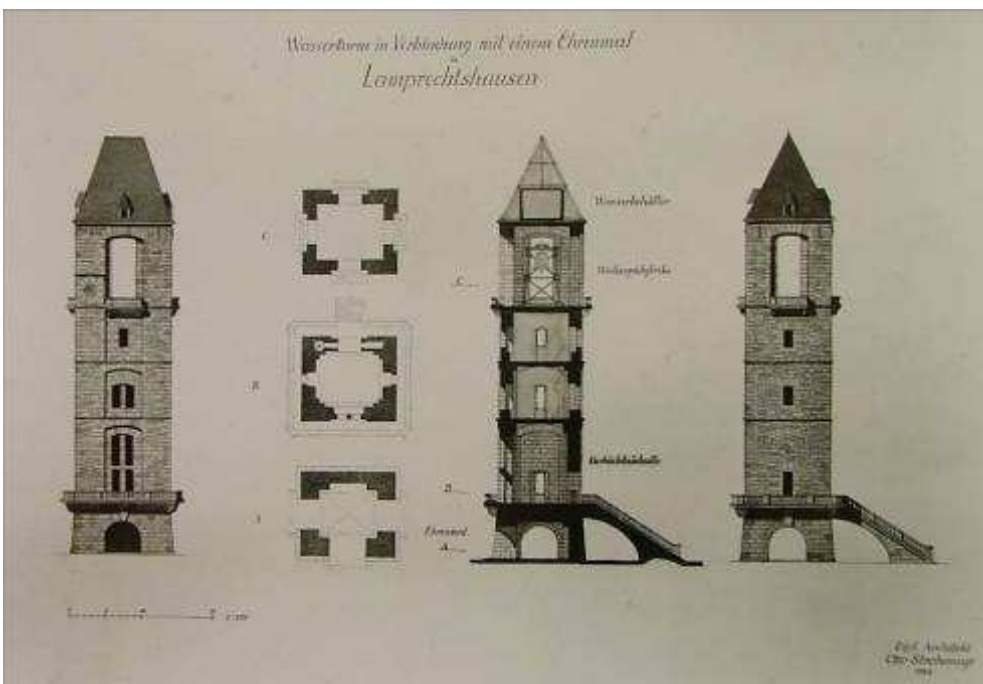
Otto Strohmayer, Ansichten, Grundrisse und Schnitt, Wasserturm in Verbindung mit einem Ehrenmal, Lamprechtshausen, 1943 (Sammlung Adlhart).
